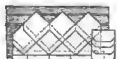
Кровельные покрытия из плоских жесткопластичных листов.
